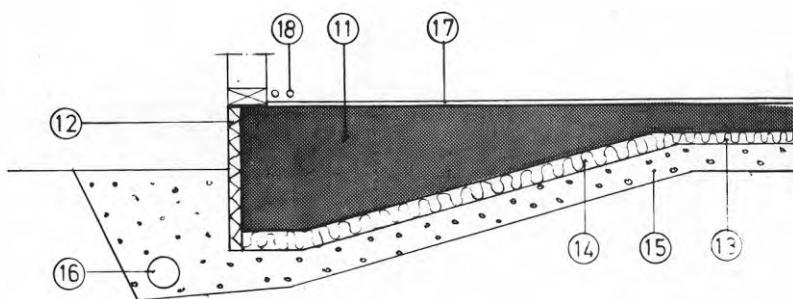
Kryprumsgrund med inneluftsventilation har i princip samma funktion som platta på mark, där värmeisoleringen ligger ovanpå plattan. Skillnaden ligger i att luftutrymmet under golvet är mycket större hos kryprumsgrunden, så att god plats finns för ledningar av olika slag. Luftvolymen i kryputrymmet har genom ventilationsspringor förbindelse med luftvolymen i rummen ovanför. Bjälklaget över kryputrymmet behöver följaktligen ingen värmeisolering. Däremot värmeisolerar kryputrymmets ytterväggar (sockeln) och botten runt om en bit in från ytterväggarna. Kryputrymmet blir varmt
